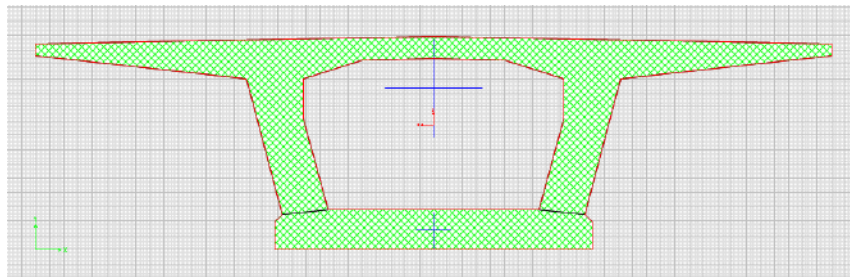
Sección del Cajón de Hormigón Ubicado sobre las Pilas
